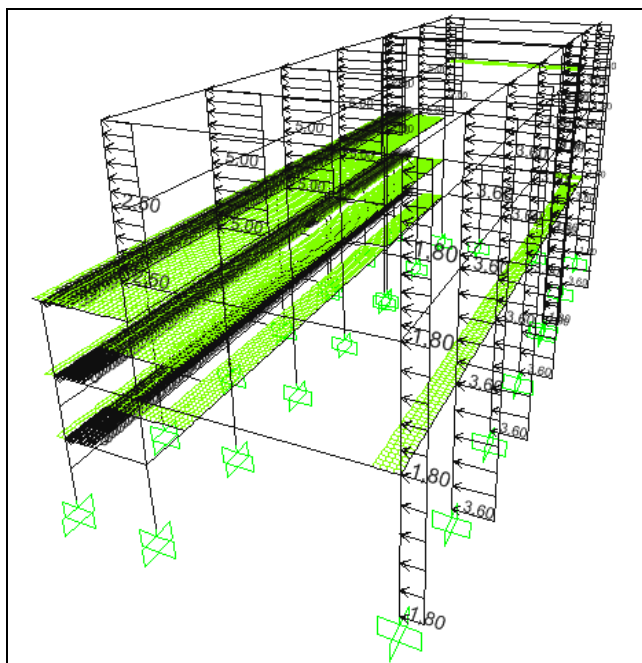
Vento_1 aplicado ao modelo (Vista de Jusante para Montante)
